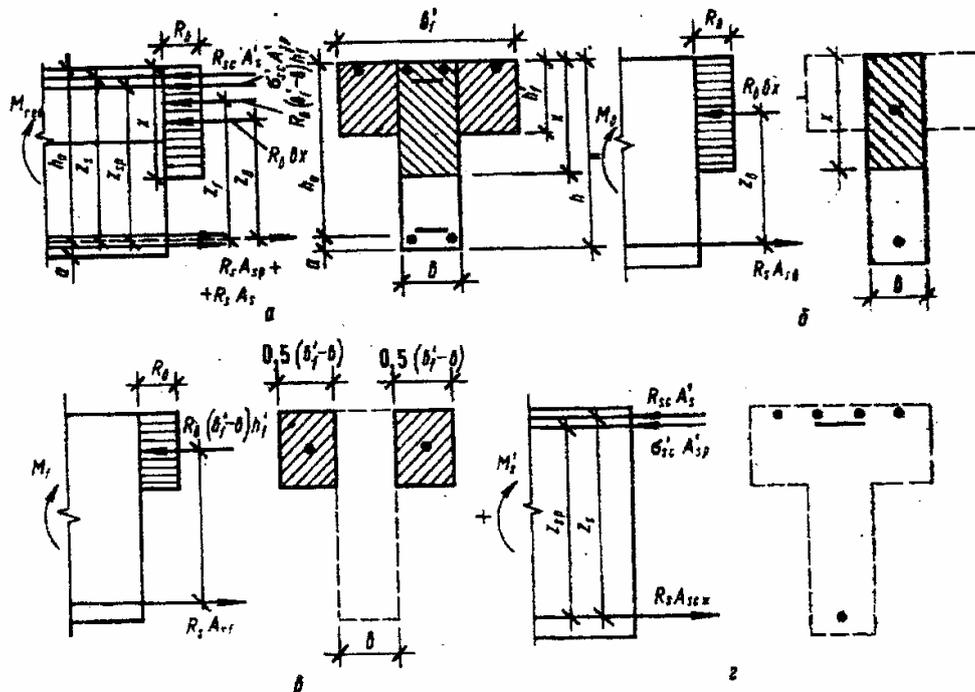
Расчетная схема таврового профиля с двойным армированием
